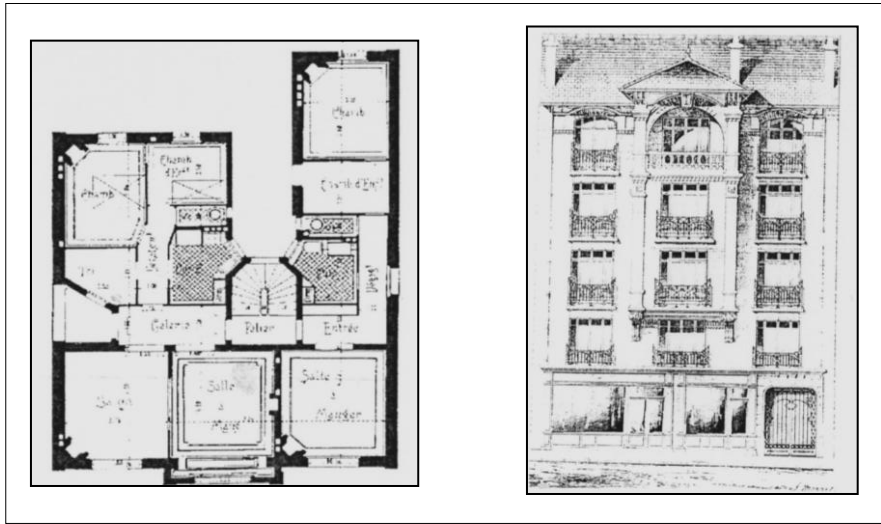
Plan et façade d'une petite maison de rapport à Clamart, A.Monod, architecte 1908
